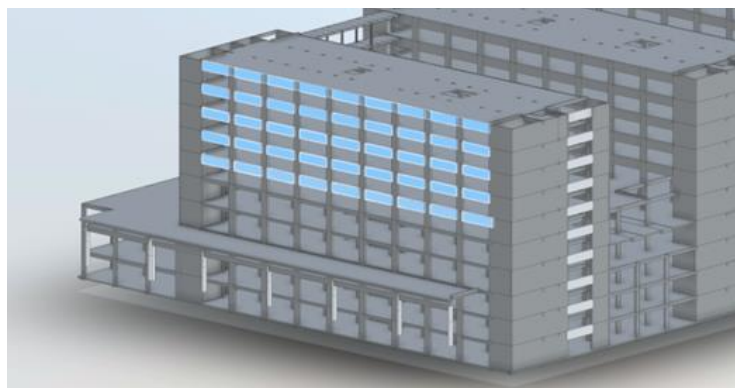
Ilustração das vigas das fachadas com secção aumentada, 0,40x1,80 m² (ARSLVT, 2026)
